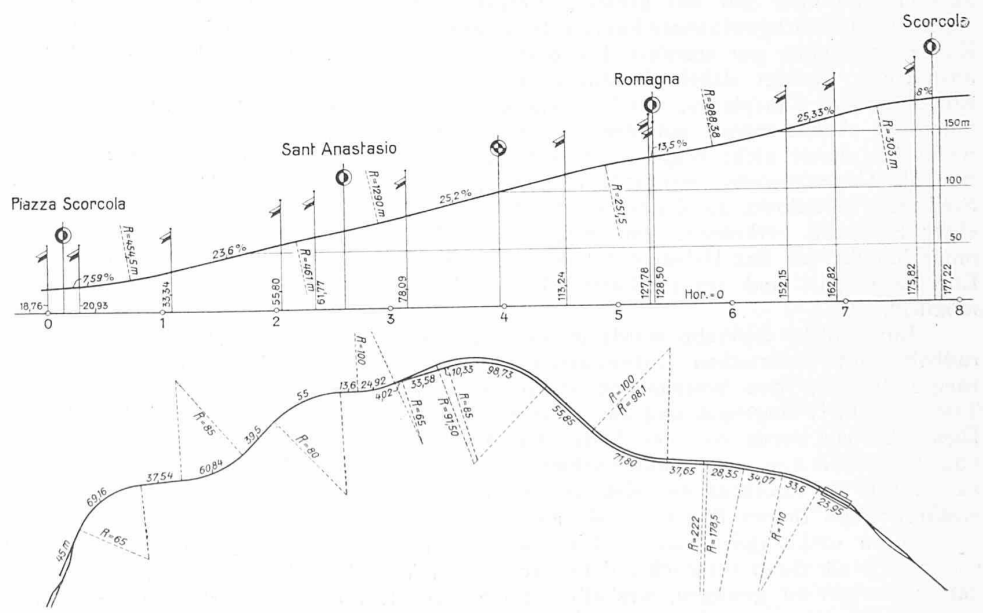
Längenprofil und Grundriss der als Seilbahn umgebauten ehemaligen Zahnstangen-Strecke der Bahn Triest-Opcina. — Masstab der Längen und Höhen 1 : 6000.
